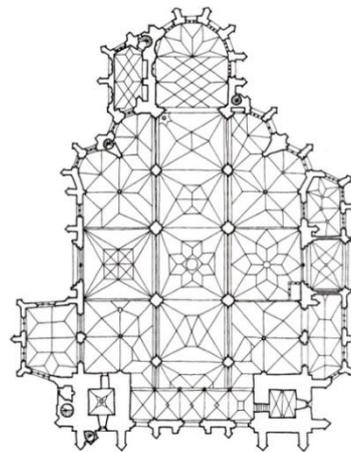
Košice, Elisabethdom, Grundriss, 1390-1496
